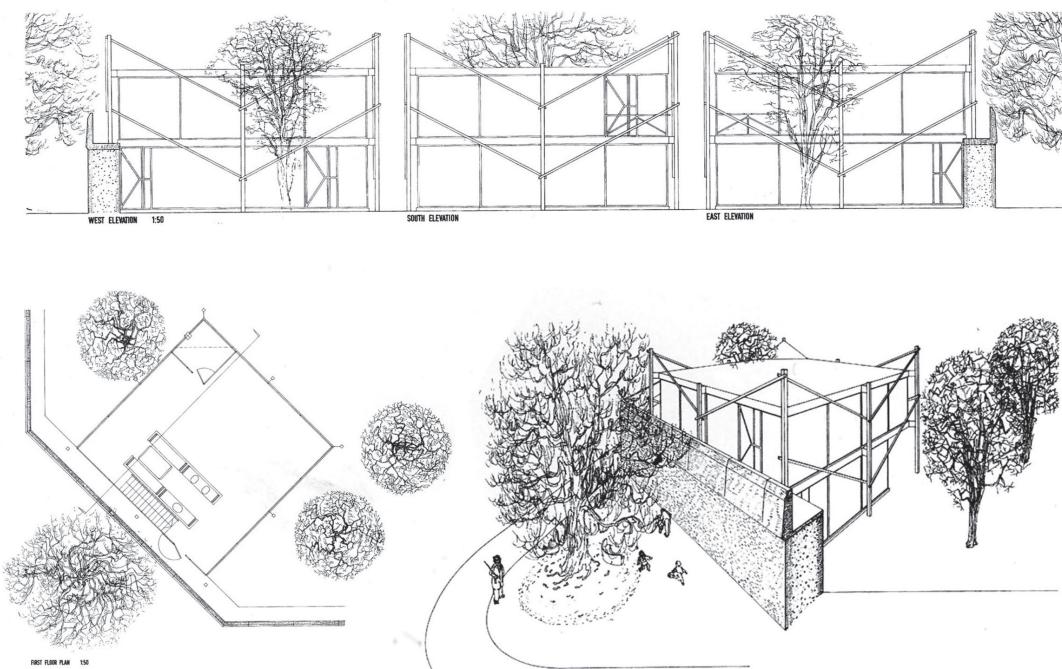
Alzados, planta baja y axonométrica de The Yellow House, primer premio del concurso convocado por la revista *The Japan Architect* en 1976.
